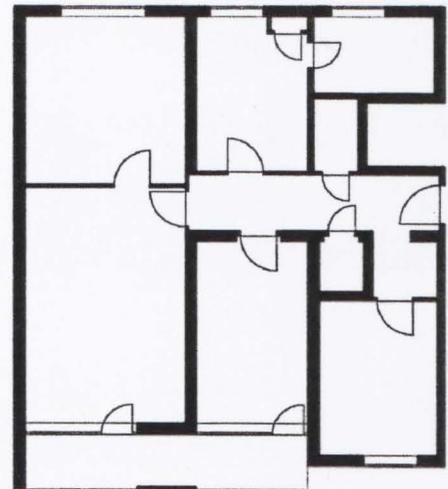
Dr. Robert-Grafstrasse 19-21 Grundriss Vierzimmerwohnung
